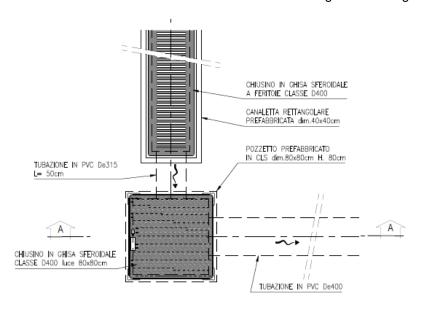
Dettaglio di scarico della canaletta centrale nel pozzetto 0.8x0.8 m.
